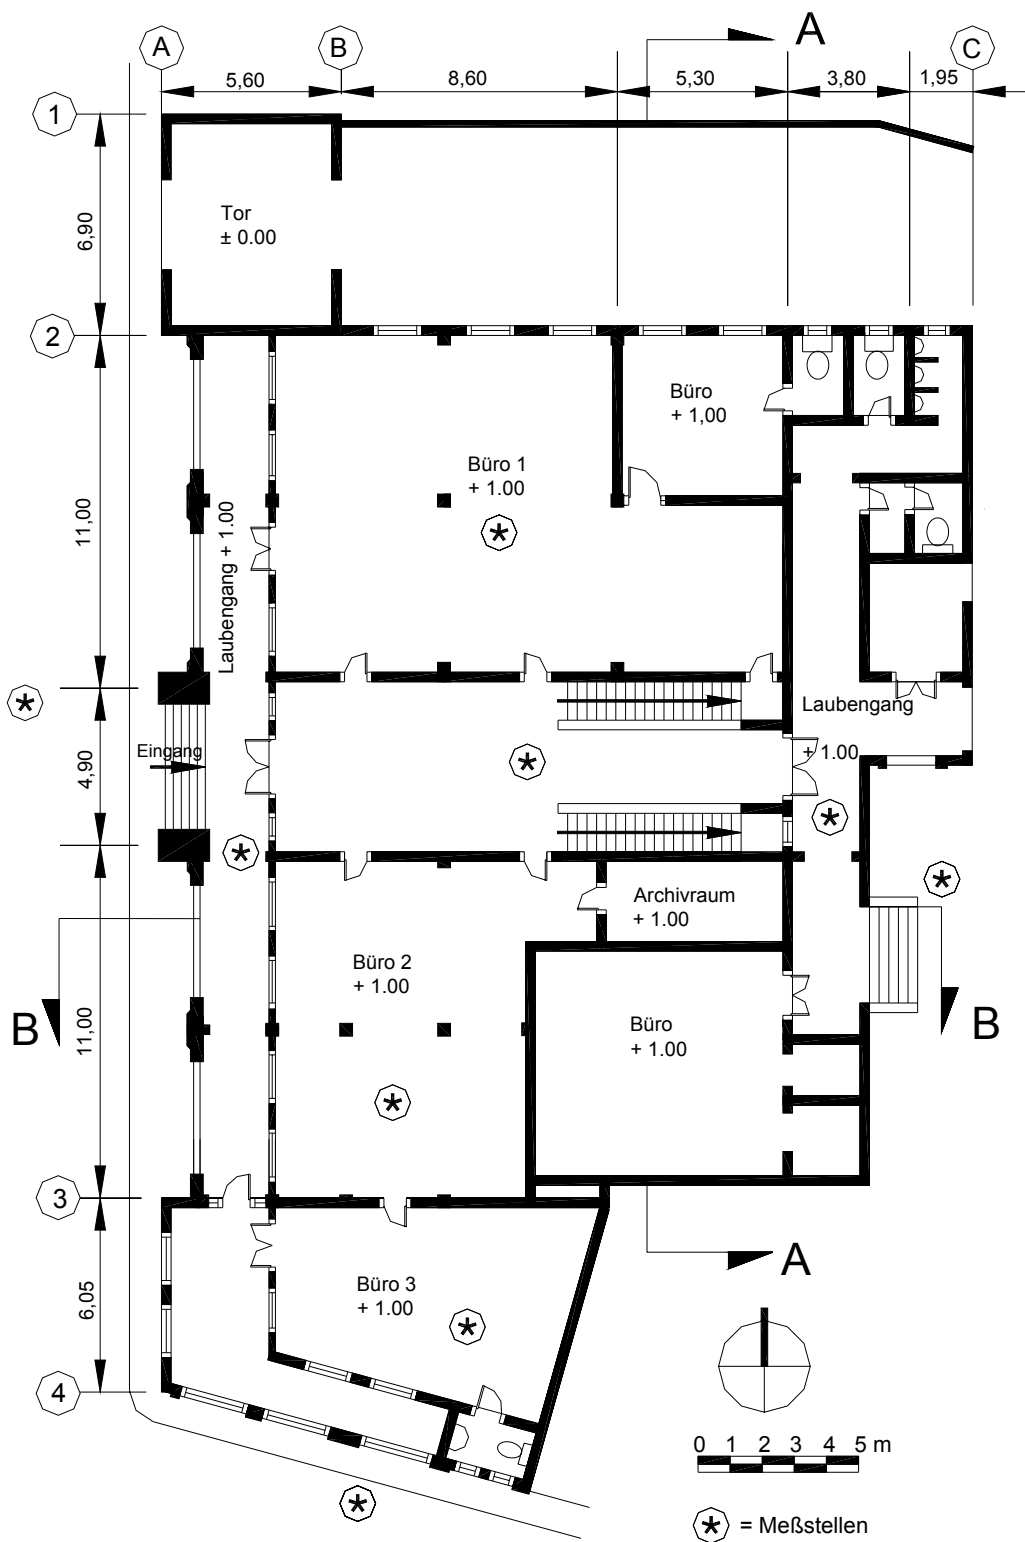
Grundriss Erdgeschoss von Gebäude C6
